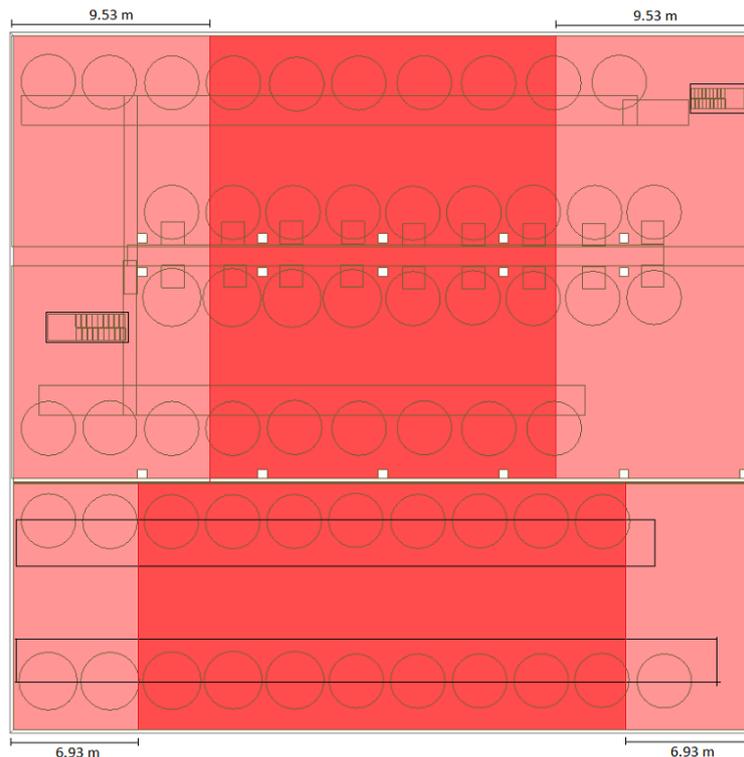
Vista en planta del almacén con las zonas de deslumbramiento señaladas. Fuente: Elaboración propia.
